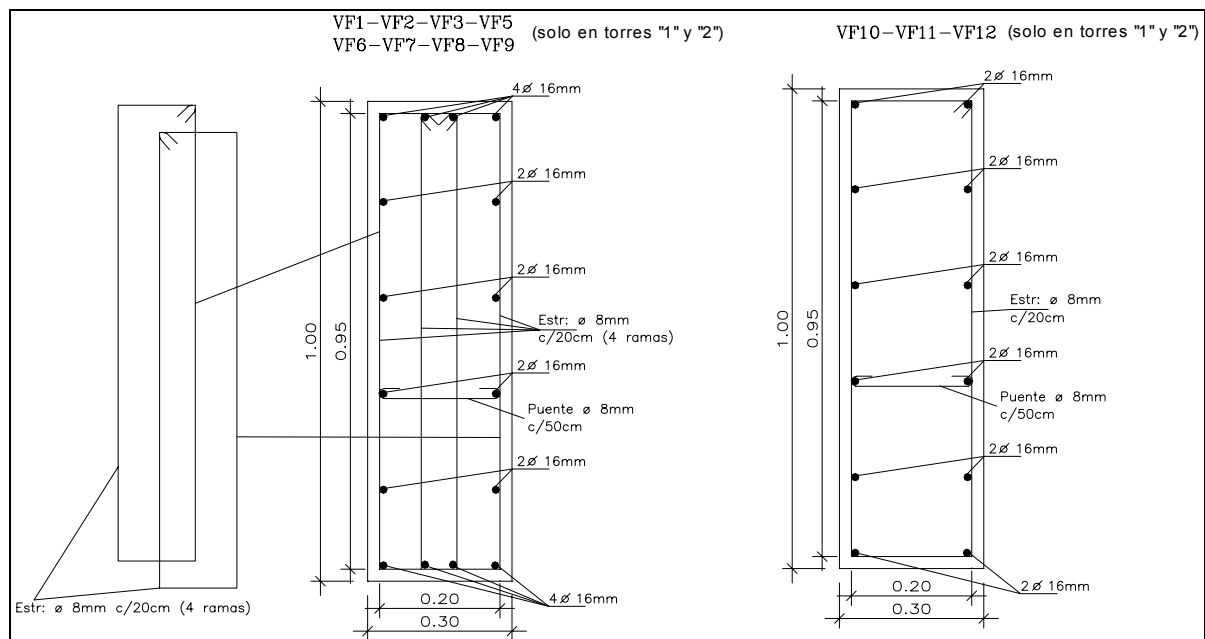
Detalle de disposición de armaduras en vigas de hormigón armado.
